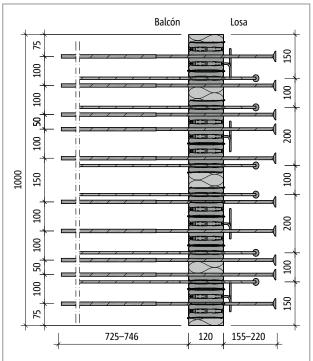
Schöck Isokorb® XT tipo K-U-M4: Plano del producto
